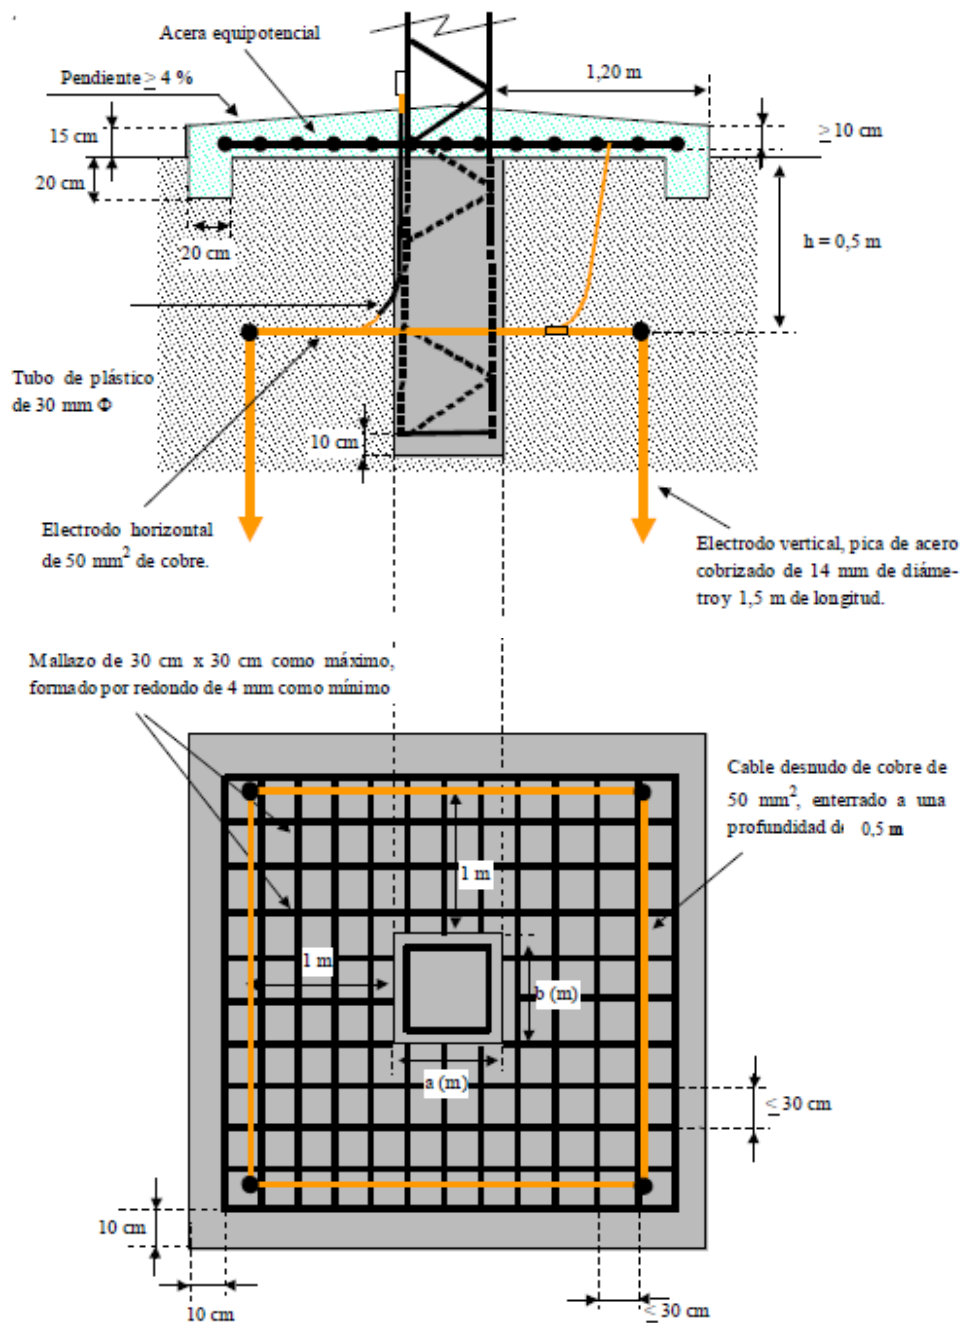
Acera de hormigón con mallazo equipotencial para apoyo frecuentado con calzado.
